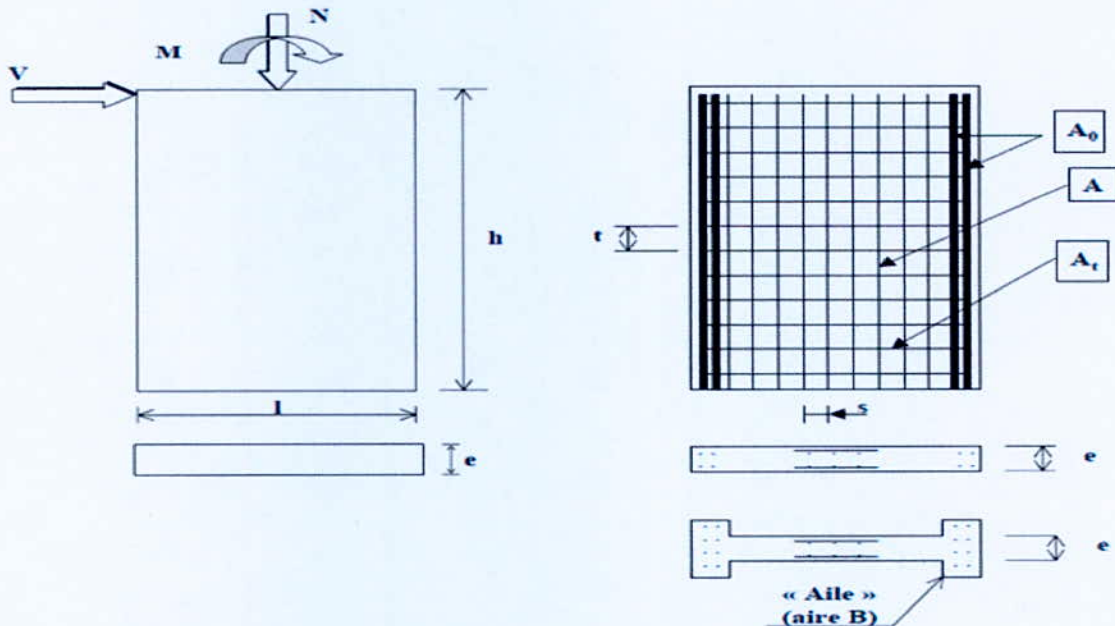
Schéma d'un voile plein et disposition du ferrailage.
